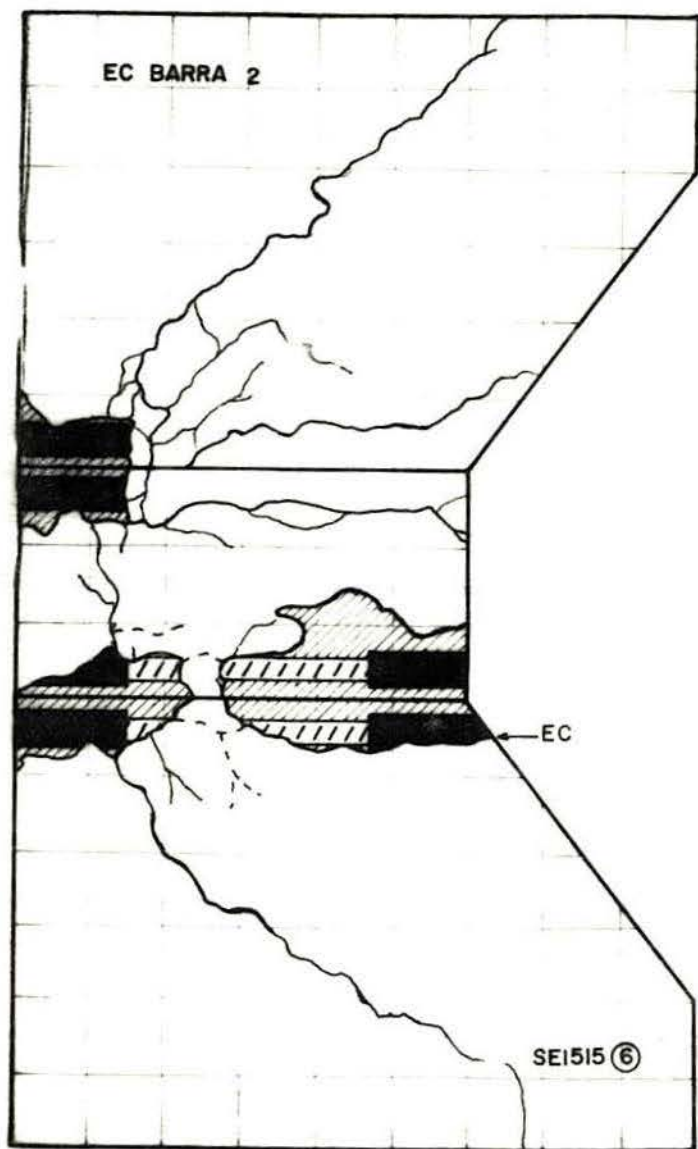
Fissuração dos CP SE1515
